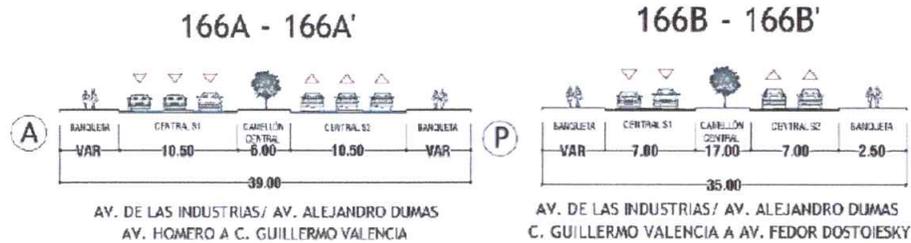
Sección vial actual y futura de la Av. De las Industrias / Av. Alejandro Dumas. Fuente PDU 2040 vigente.
